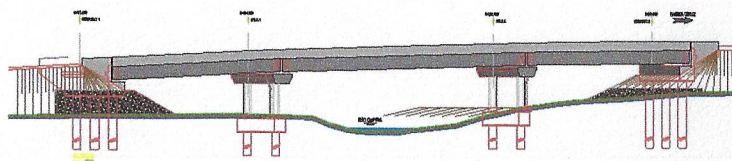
Esquema del alzado oeste del puente aguas arriba
